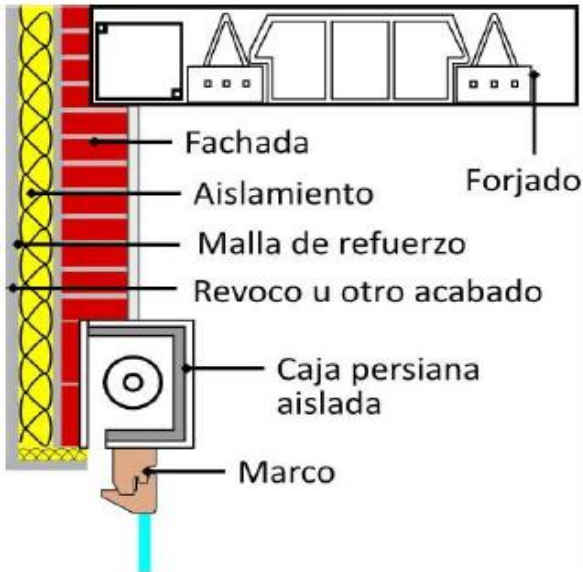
Aislamiento por el exterior. Detalle dintel de ventana.
